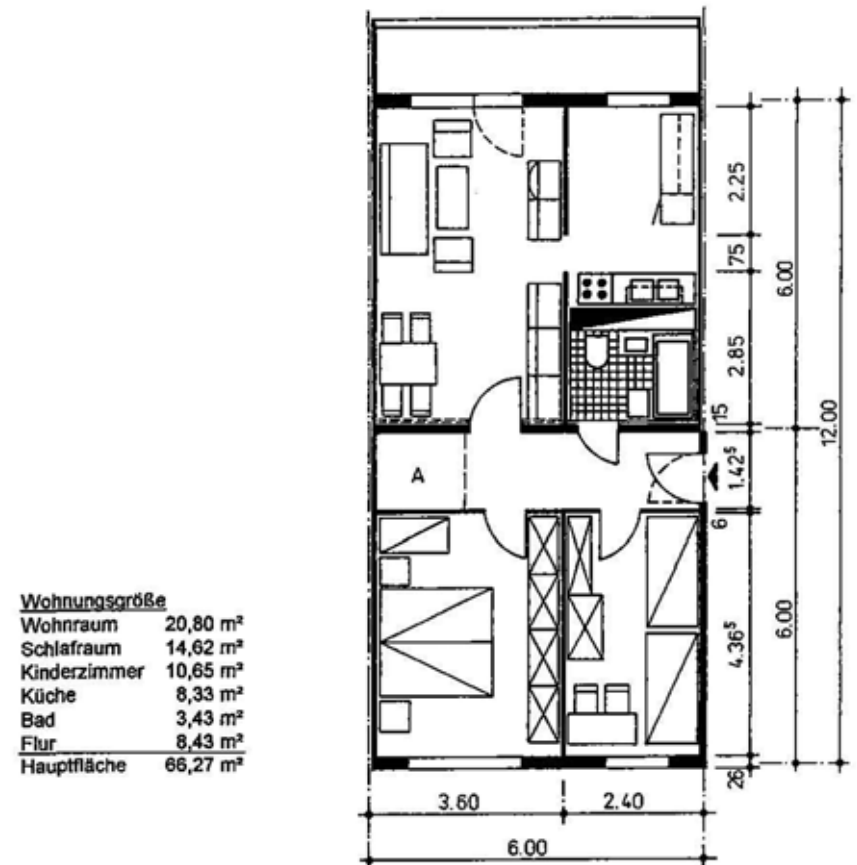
Grundriß einer 3-Raumwohnung mit Außenküche
